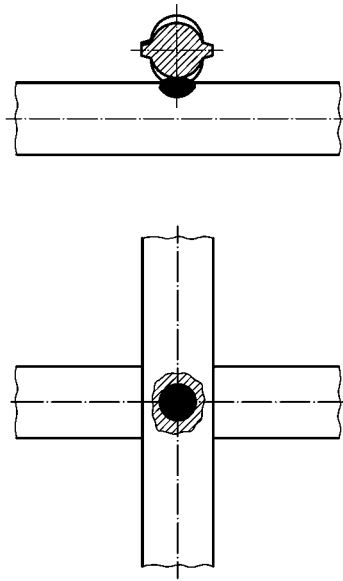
Kreuzungsstoß, Schweißprozesse 21 und 23
